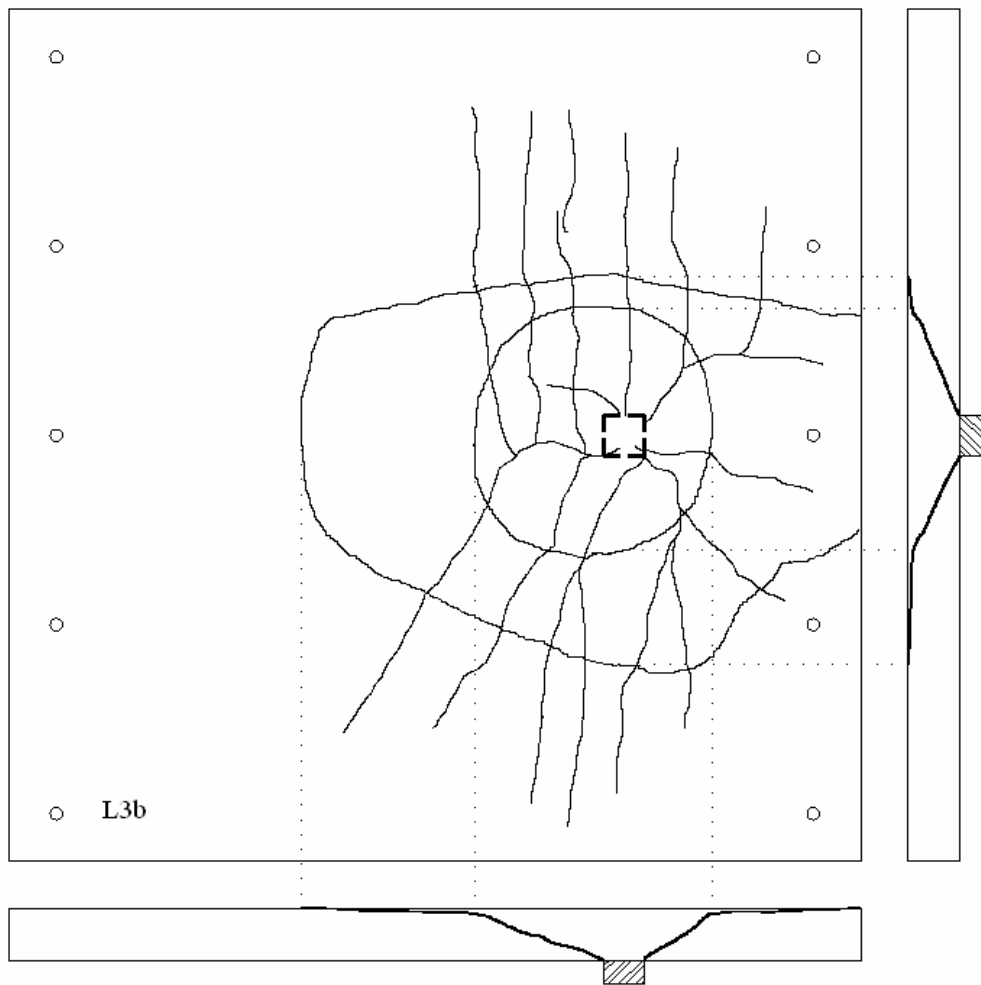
Mapa de fissuração da laje L3b
